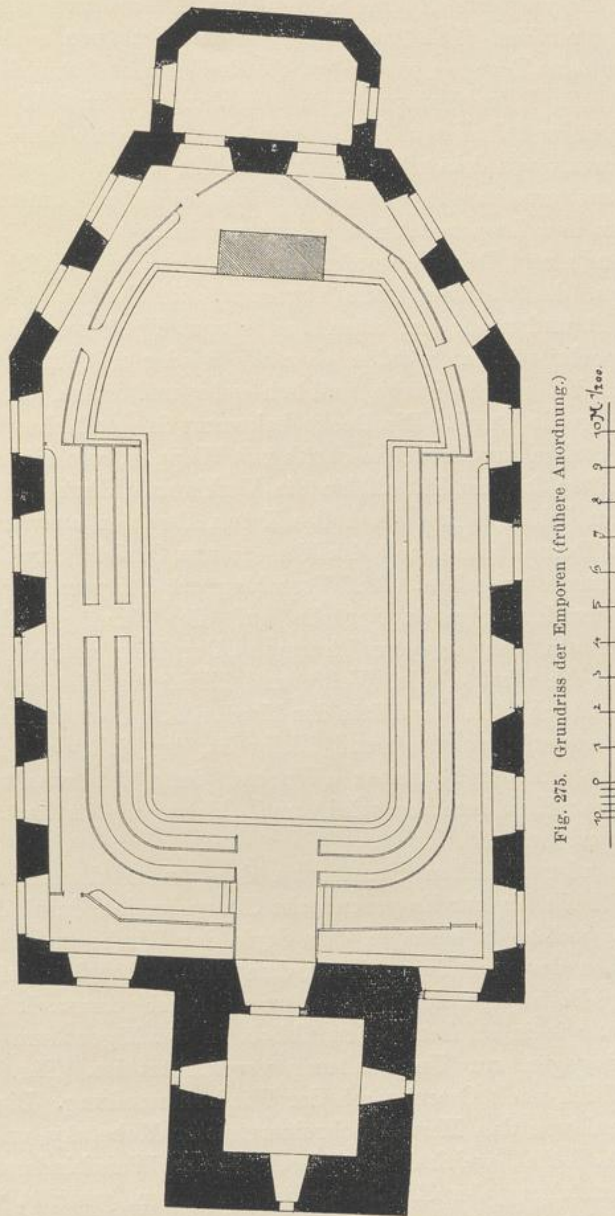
Grundriss der Emporen (frühere Anordnung.)
